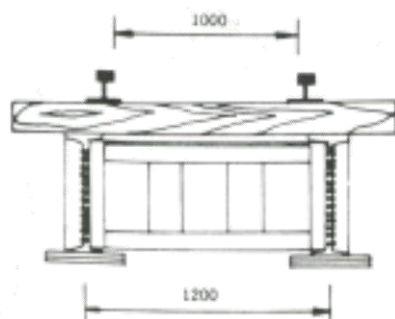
สะพานไม้ (Timber Bridge)
